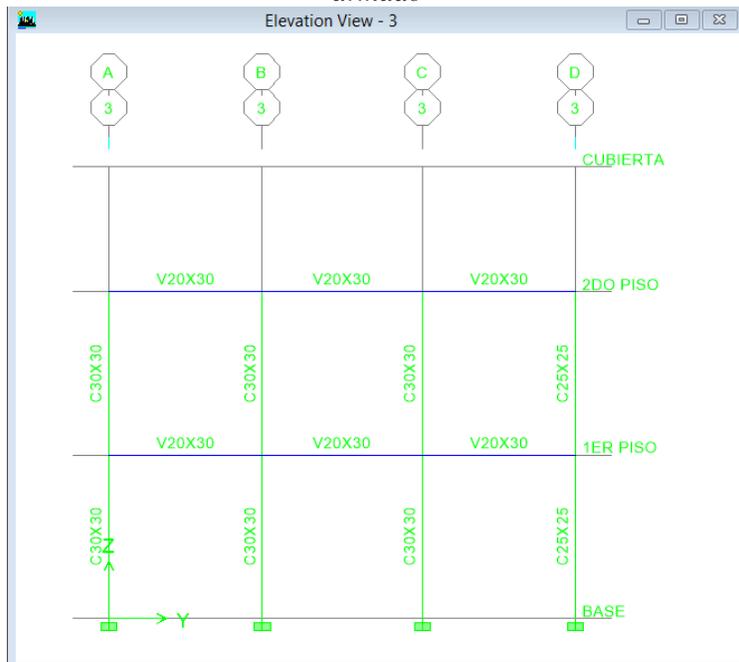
; Secciones Asignadas EJE 3 Del diseño estructural de hormigón armado
